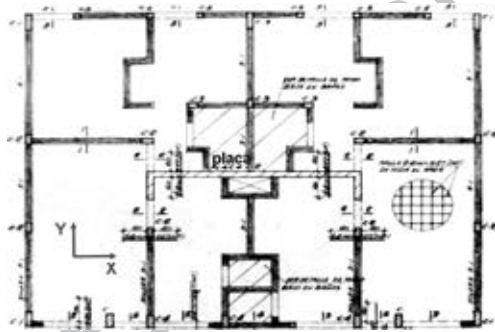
Planta típica de un edificio de albañilería confinada
